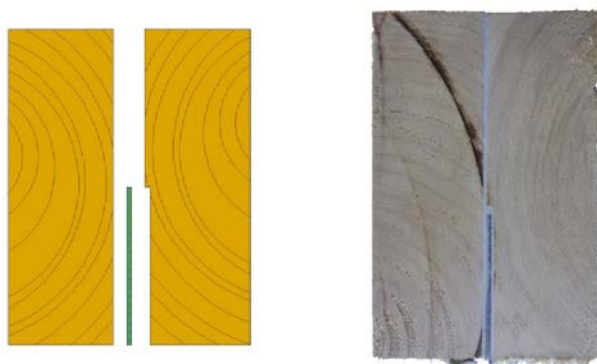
Detalle de la sección de las vigas dúo fabricadas.
